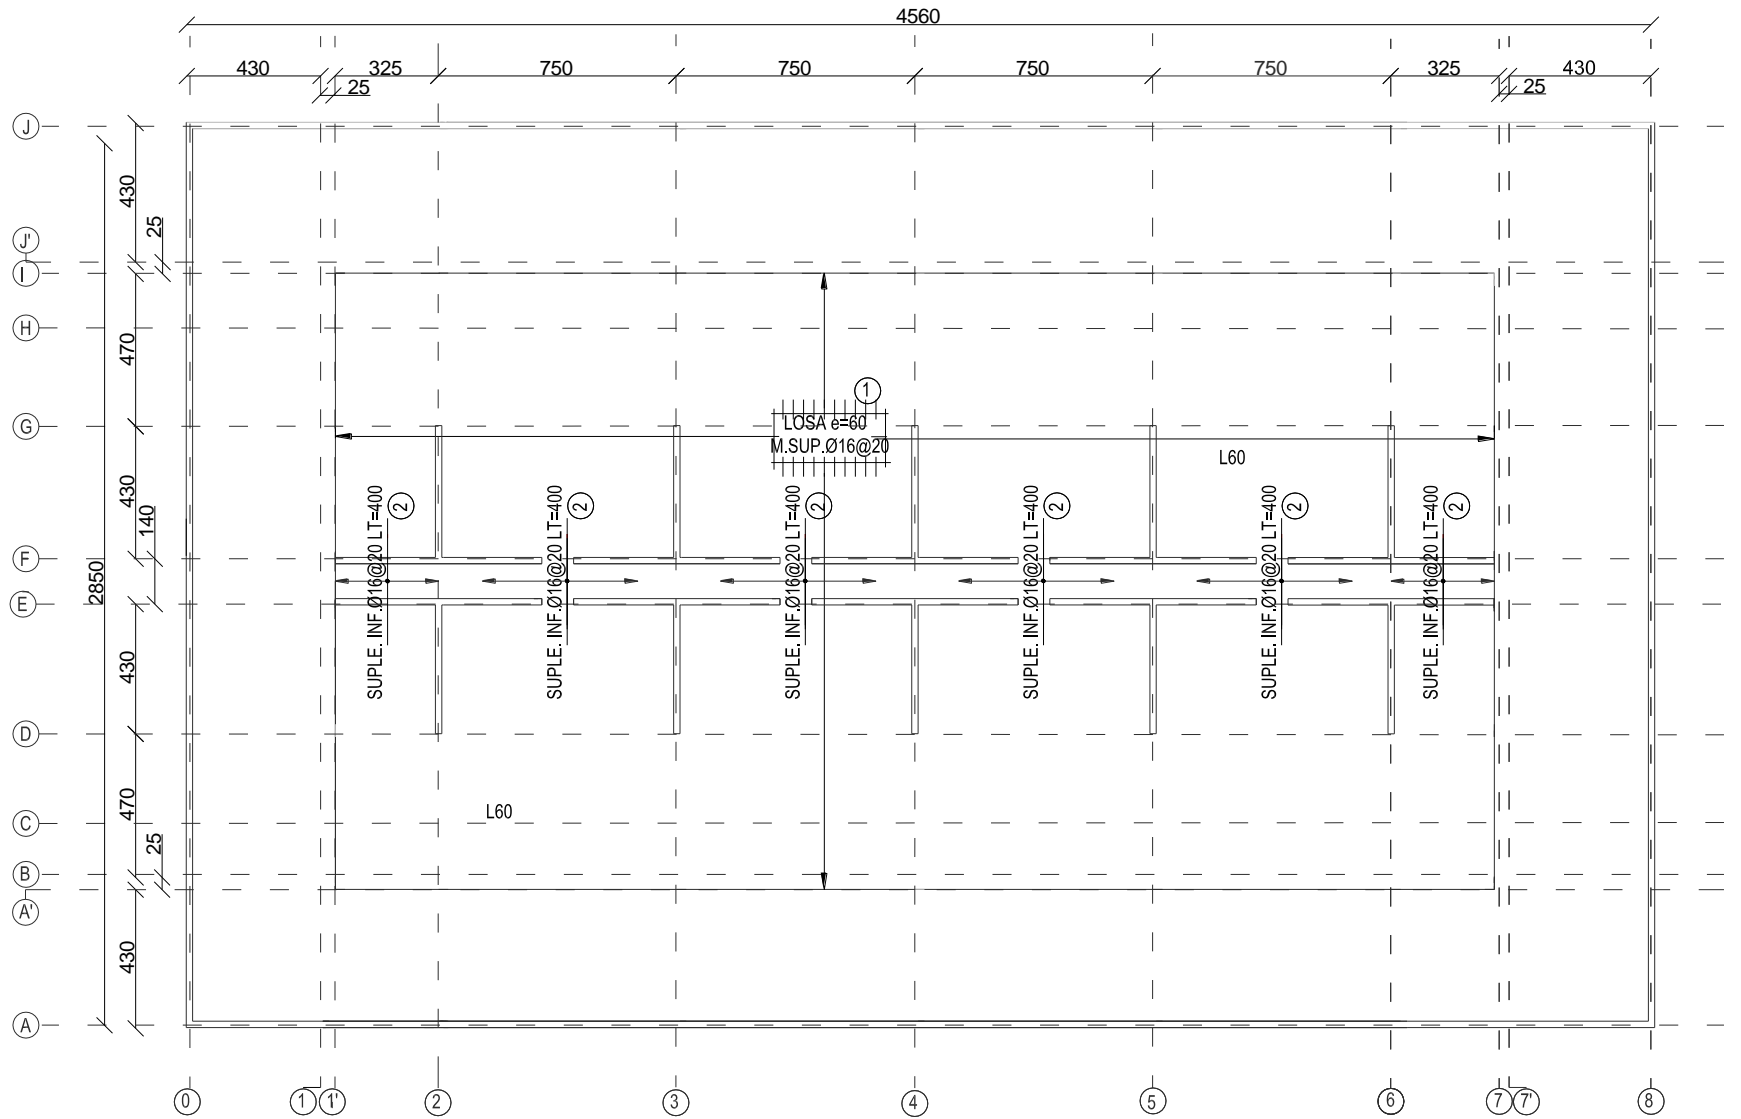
Planta losa de estabilización armadura superior de edificio aislado.
